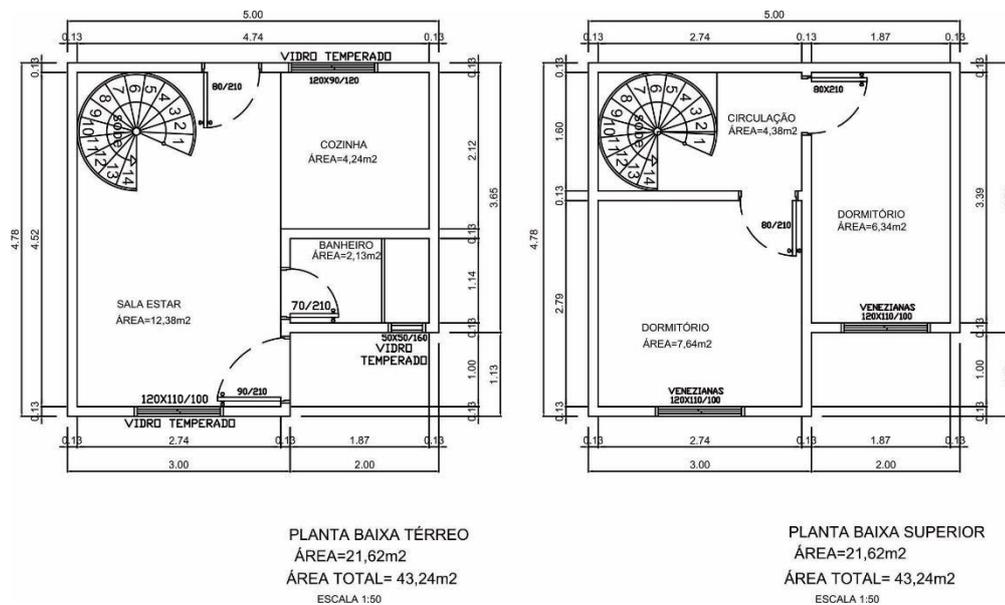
Planta Baixa das moradias do Condomínio Arquiteta Luciana.
